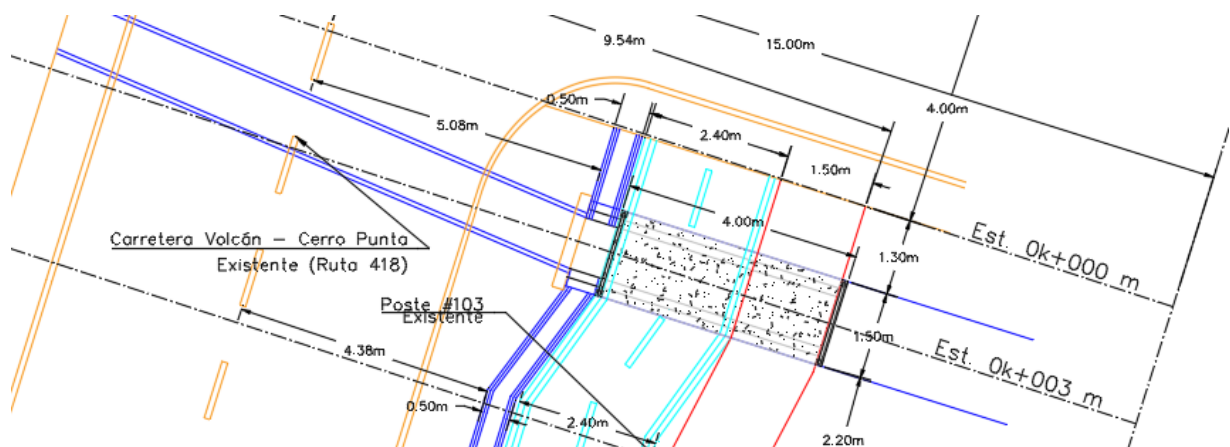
Vista de Planta 1/B, Cajón Pluvial en la estación 0K+003 m.
